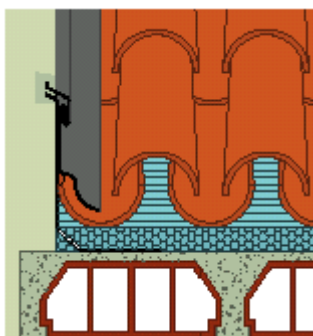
Detalle del encuentro entre el faldón de cubierta inclinada y el cerramiento. Colocación de babero.
